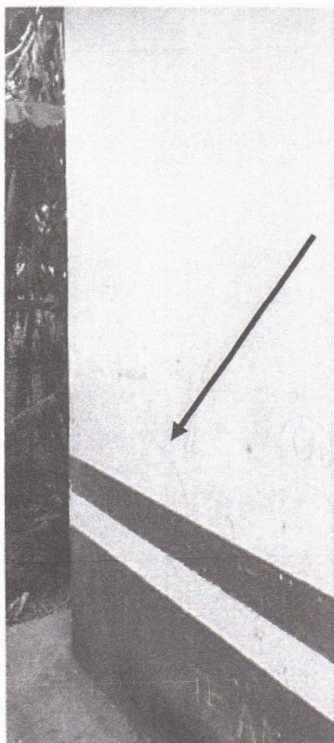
Identificação de fissura em 45° oriundas do solo, ocasionando descolamento da alvenaria em área externa da escola.
